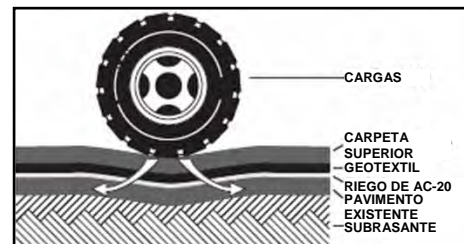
REDUCCIÓN DEL DESGASTE DE LA CARPETA SUPERIOR
